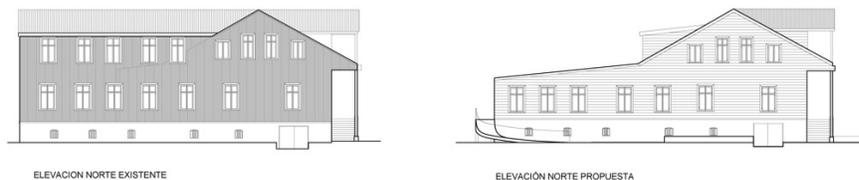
Elevación norte actual y propuesta (fuente: elaboración propia, 2022).
